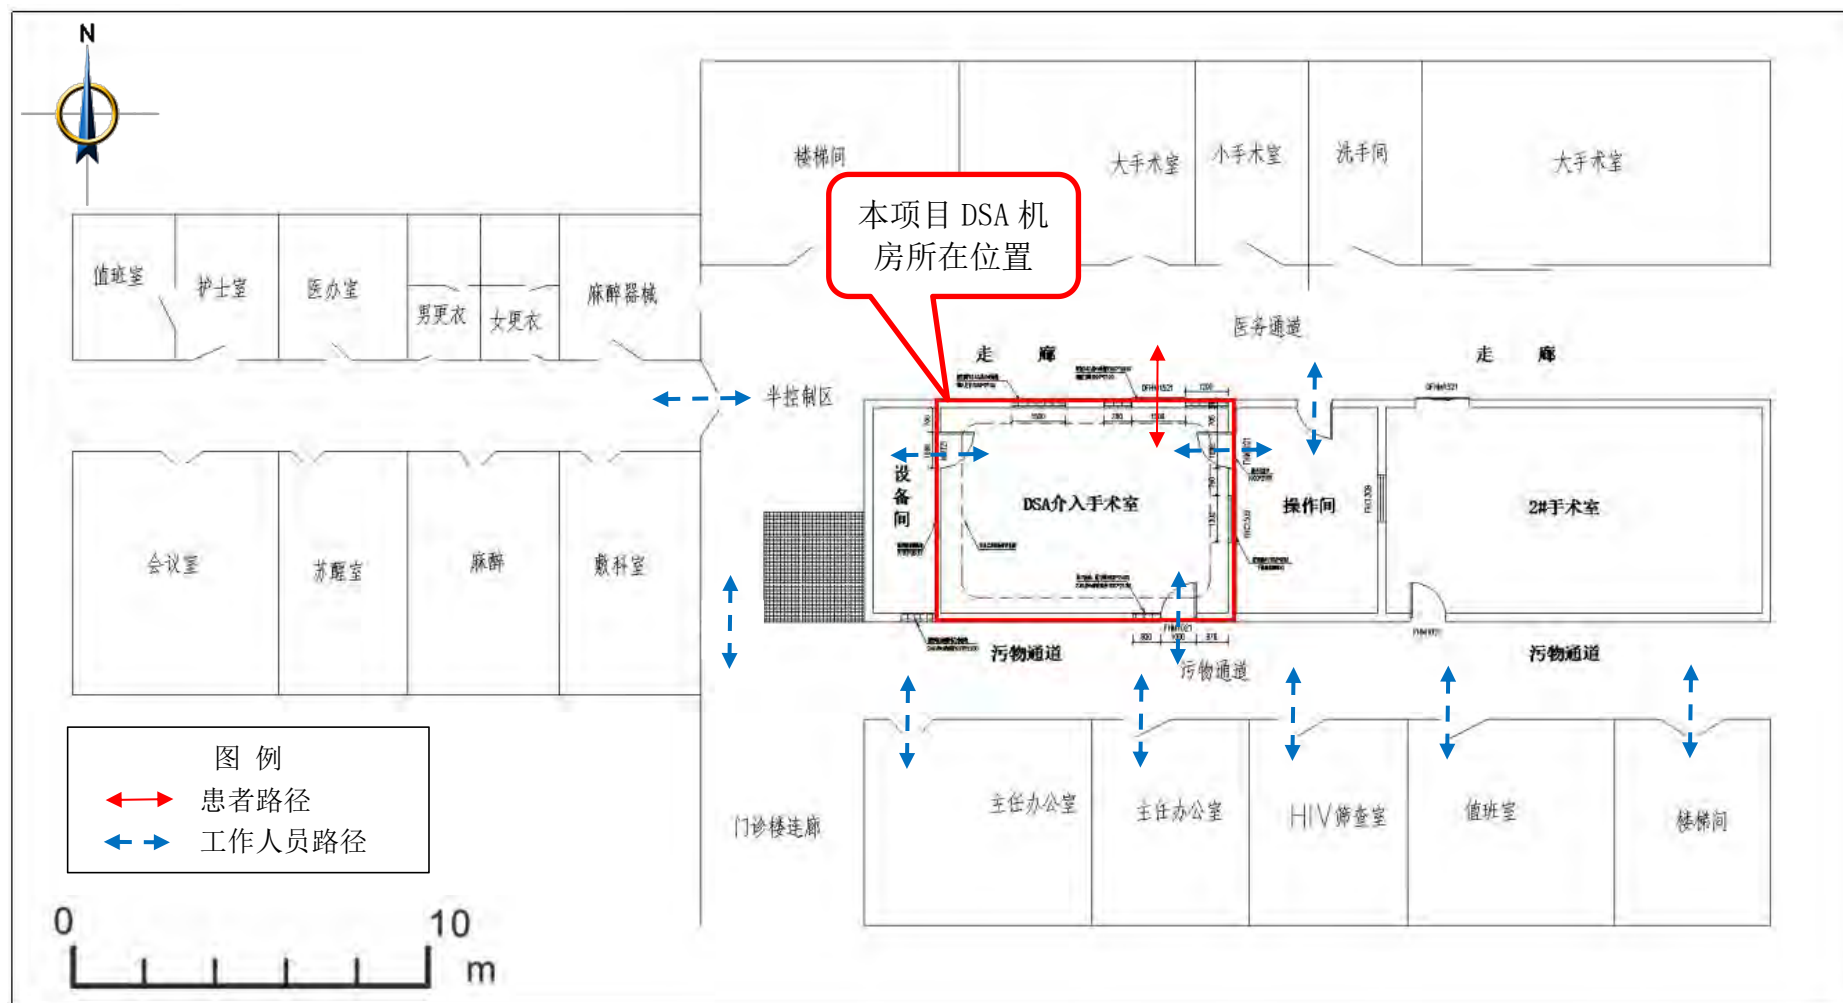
本项目改造后 DSA 机房所在楼层（三楼）局部平面布置图
